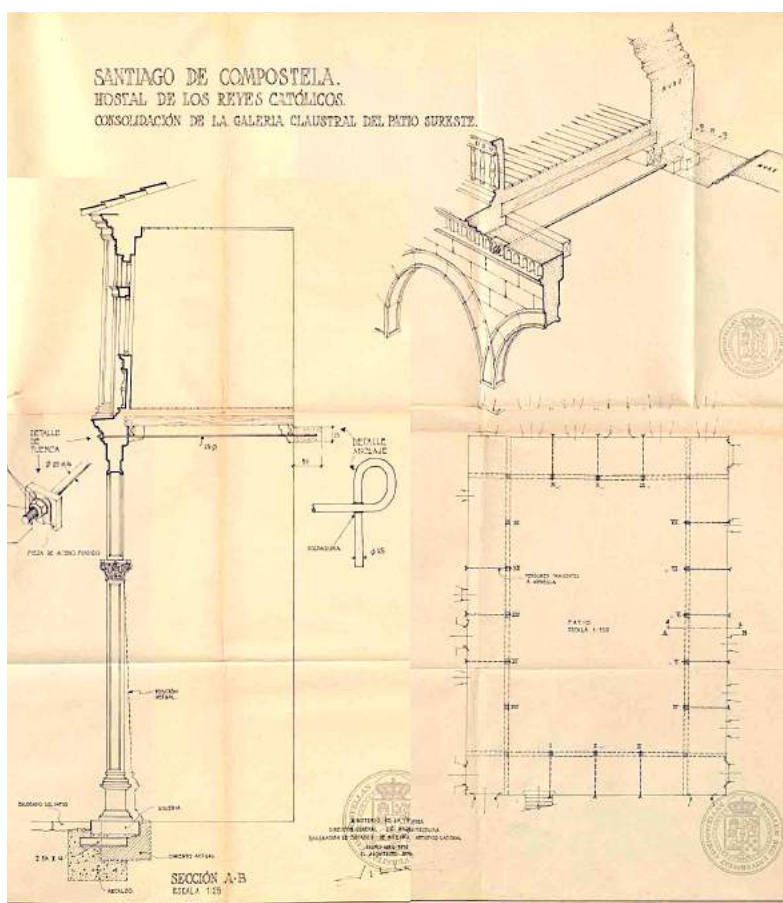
Proyecto de consolidación de la galería claustral del Patio Sur Este, 1970. Fuente: A.H.U.S. / RL 114
